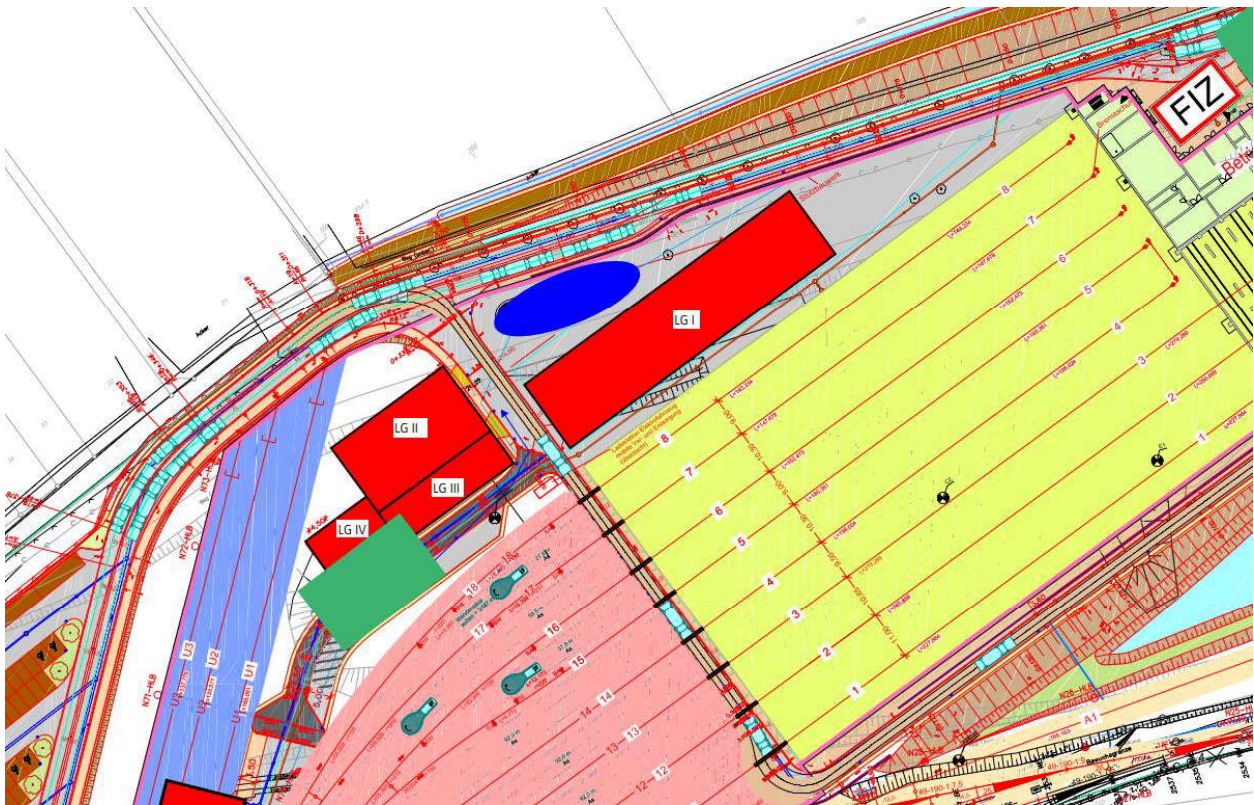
Ausschnitt aus dem /Lageplan/ mit Darstellung der Lagergebäude I – IV (rot)
